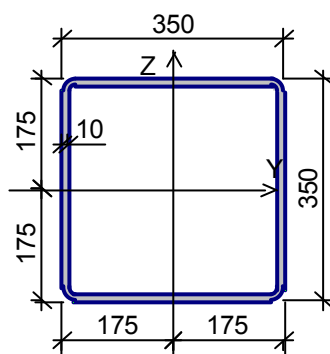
Принятое поперечно сечение нижнего пояса фермы
